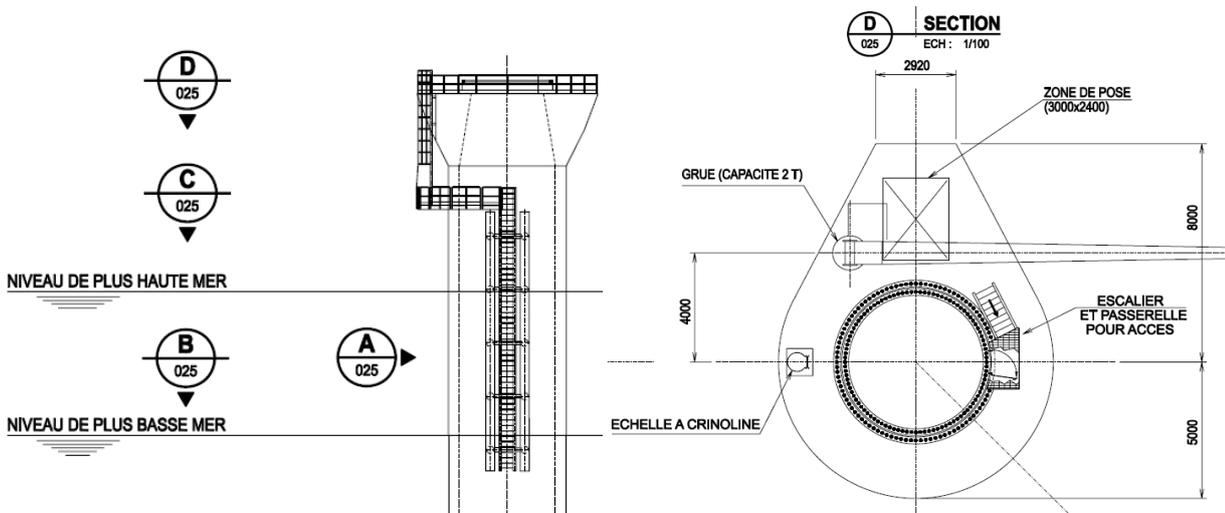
Passerelles d'accès (vue de face) et plateforme de travail (plan)
